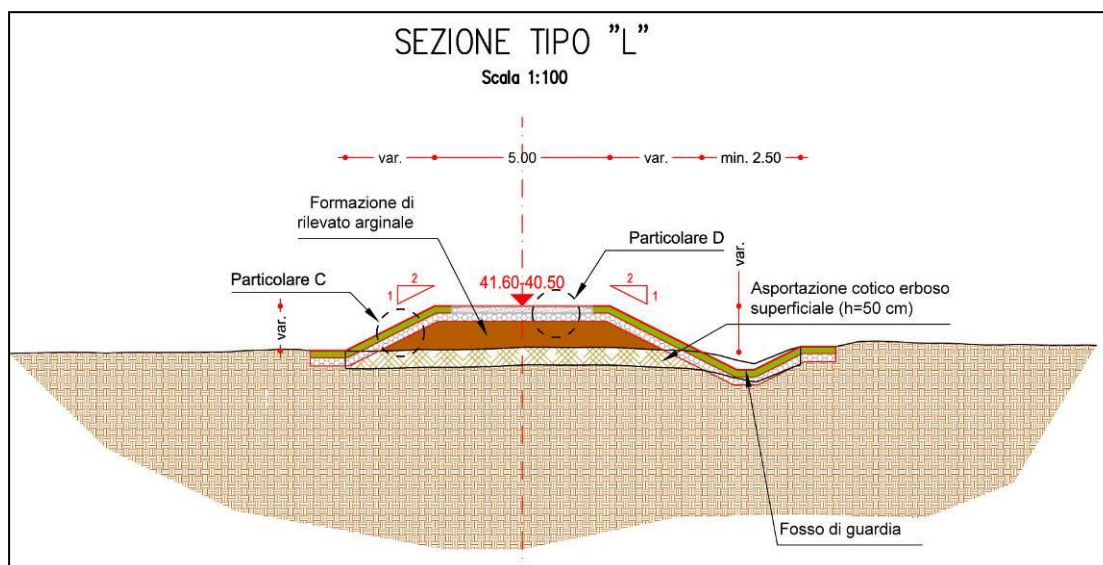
sezione tipo dell'argine in progetto nell'intervento E
